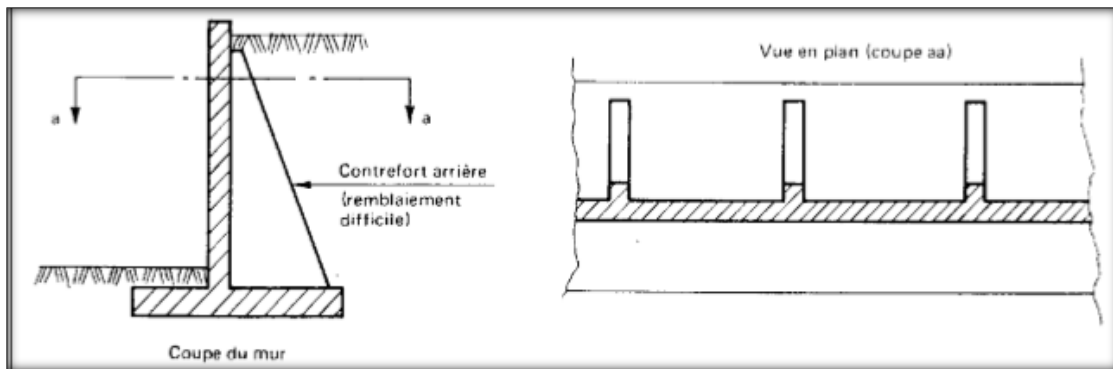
Mur cantilever avec contrefort arrière, vue en plan.
